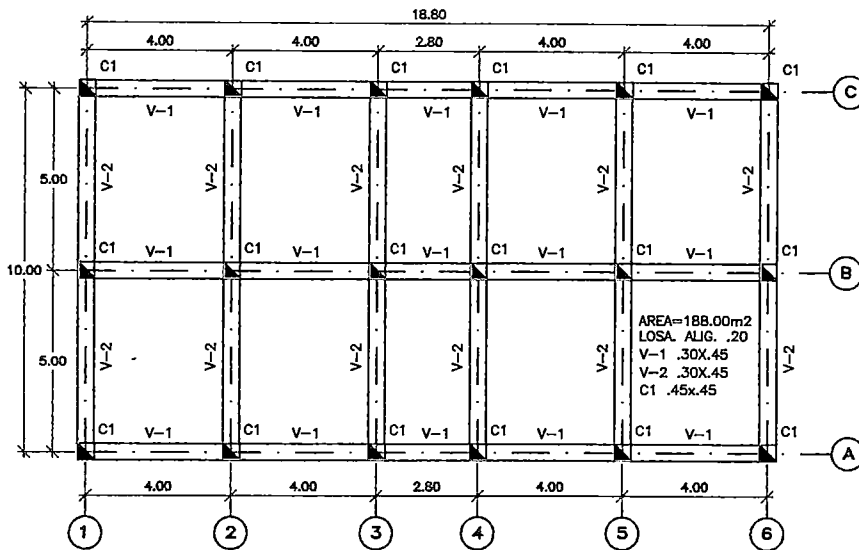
MODELO 01 PLANTA TIPICA
